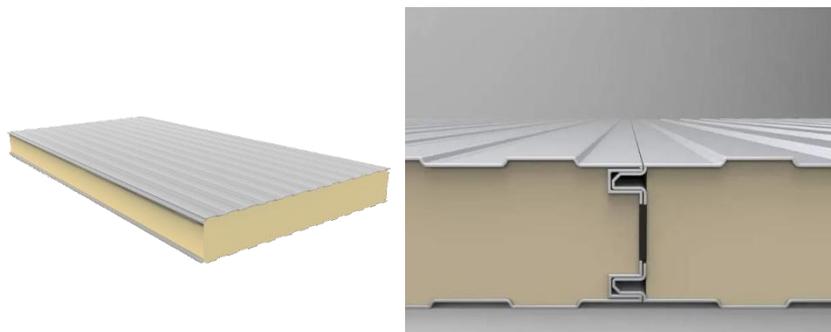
Panel aislante tipo sándwich para cámaras de congelación
